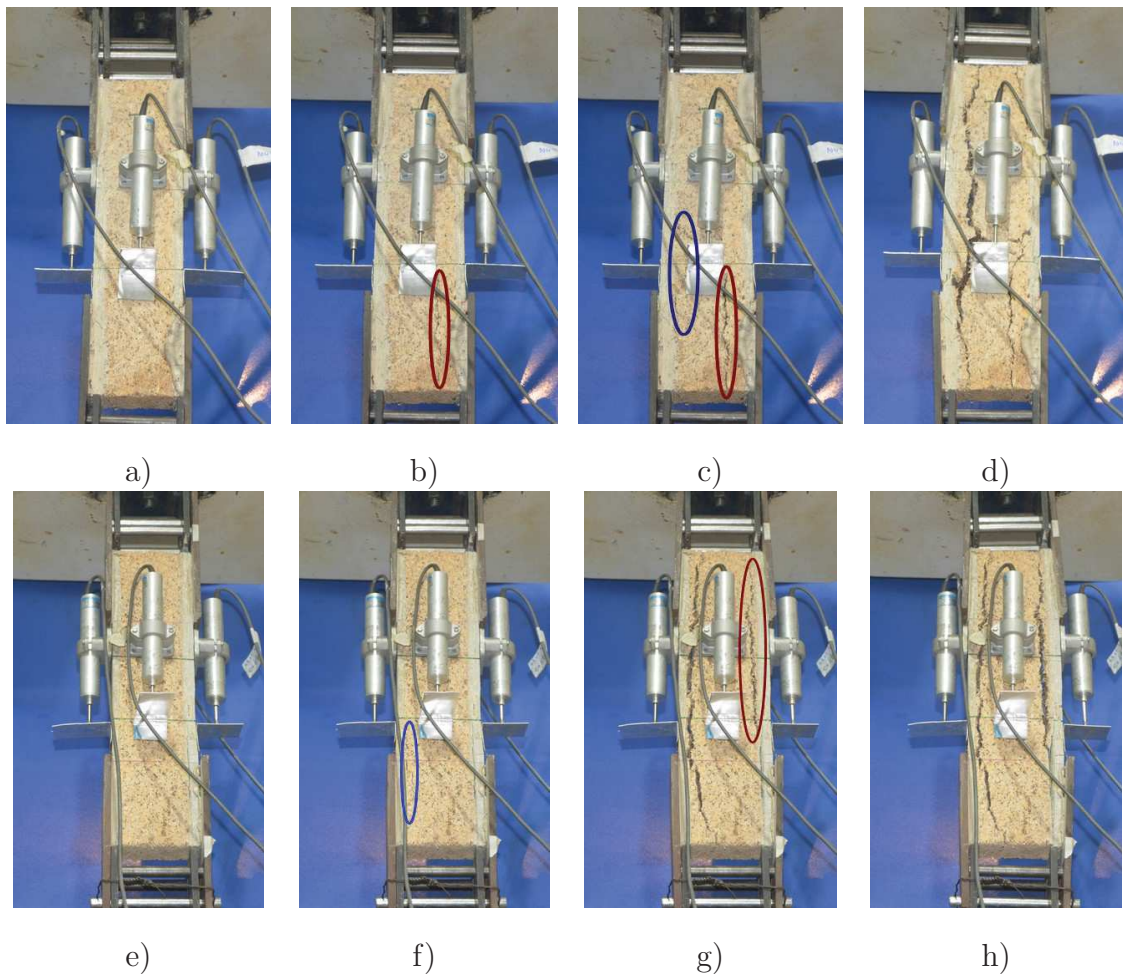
Ruptura dos núcleos de dois PS 0,5: (a,e) Início do ensaio de tração direta, (b,f) Surgimento da 1ª fissura, (c,g) 2ª fissuração (d,h) Final do ensaio
